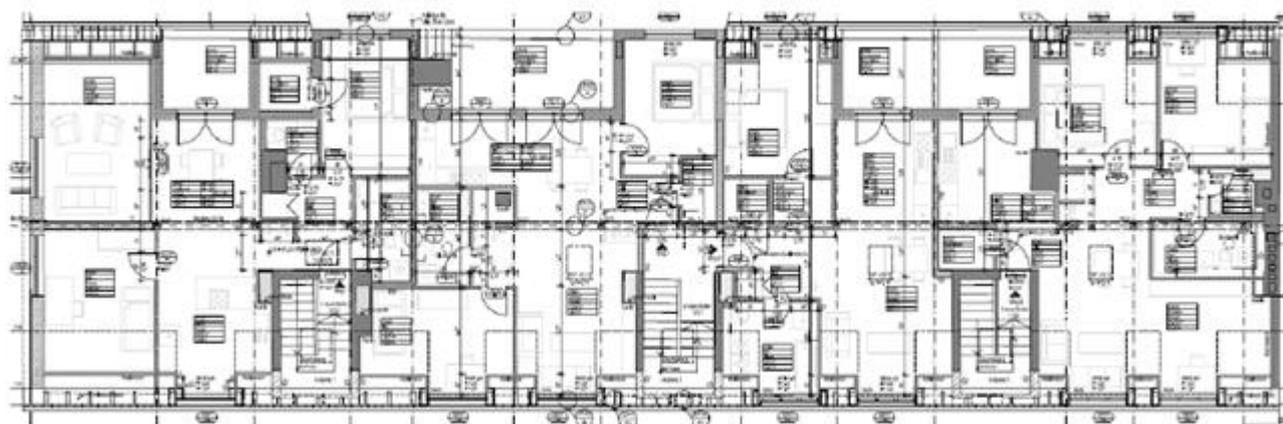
Grundriss Dachaufstockung Fallstudie 2, TeLA.
